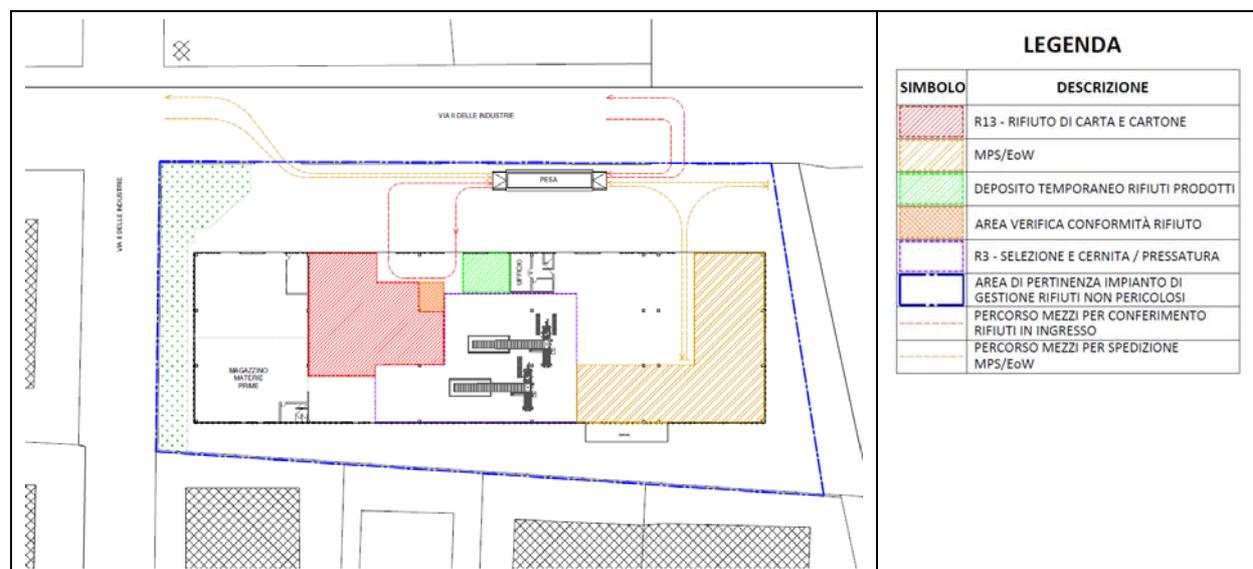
Layout dell'impianto (estratto della Tavola 4 di progetto)
